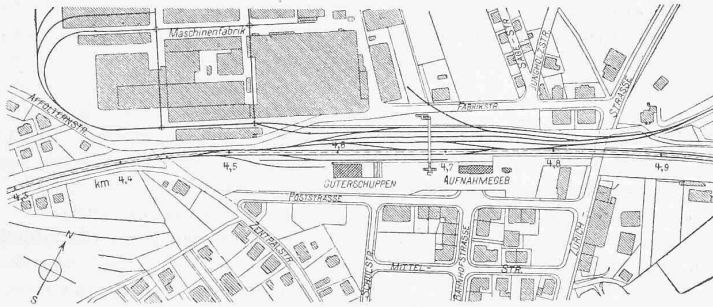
Lageplan der Station Oerlikon im Jahr 1904. — Masstab 1 : 6000.
